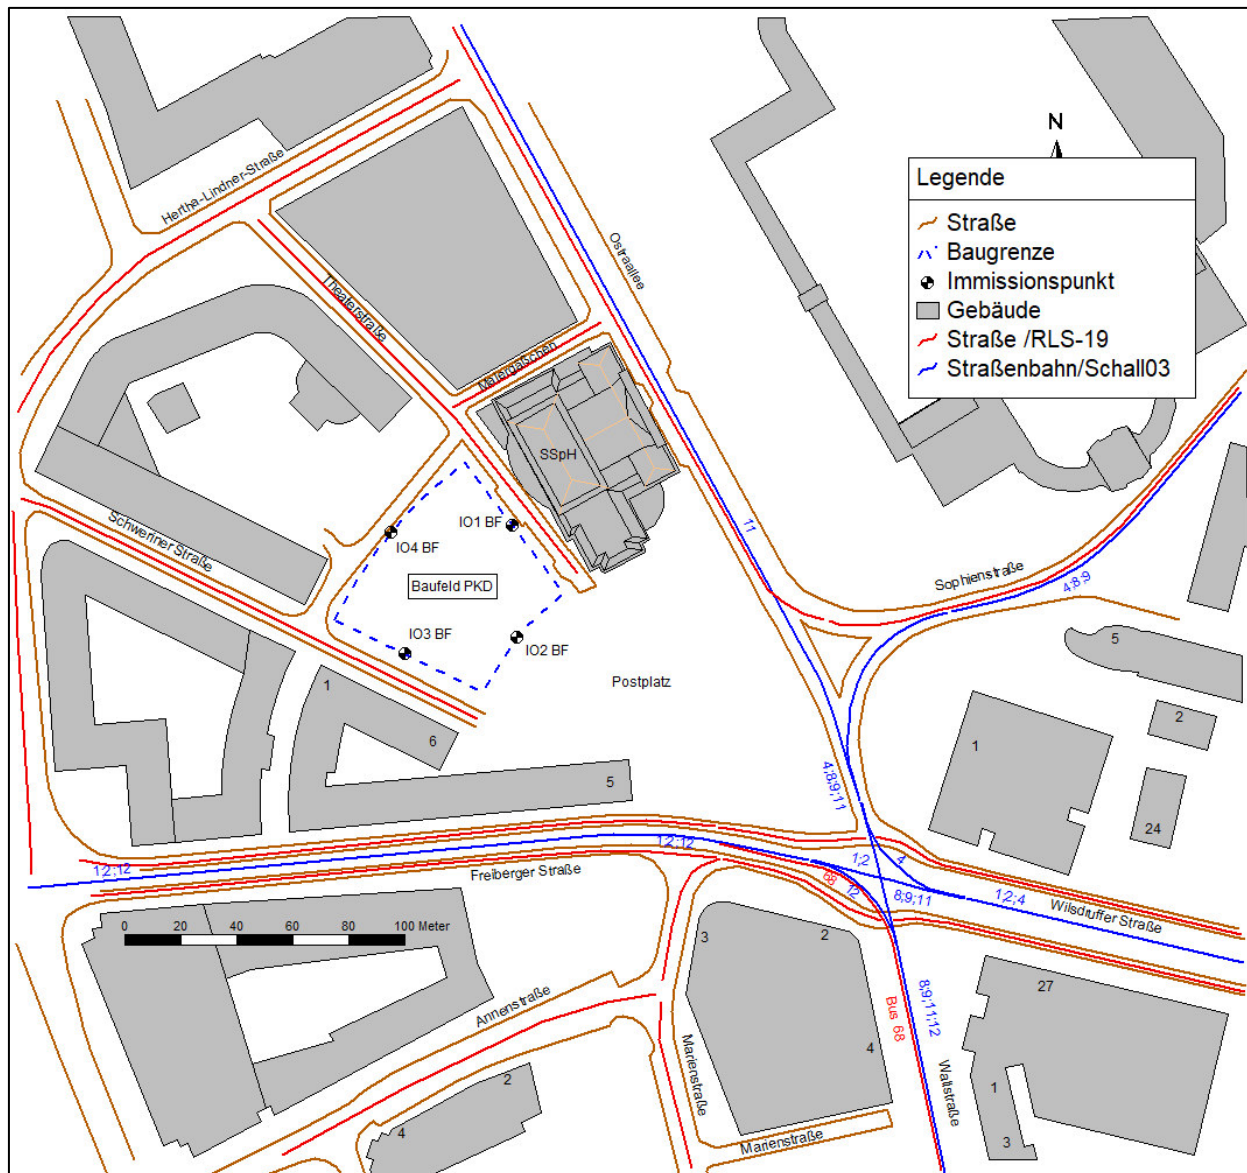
Lageplan (Rechenmodell) mit dem Baufeld PKD sowie den Immissionsorten auf der Baugrenze
